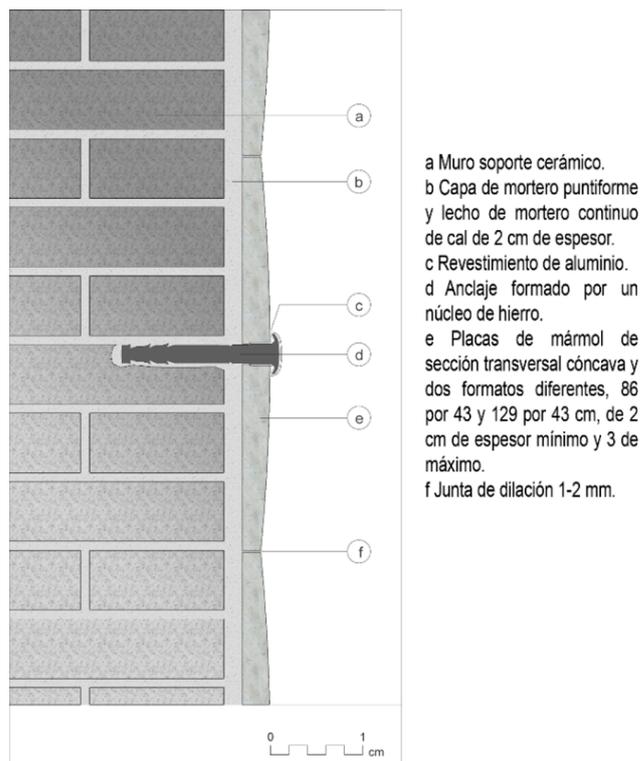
Detalle constructivo despiece que enmarca el vano central Postsparkasse (Gallego-Blázquez, R.).
